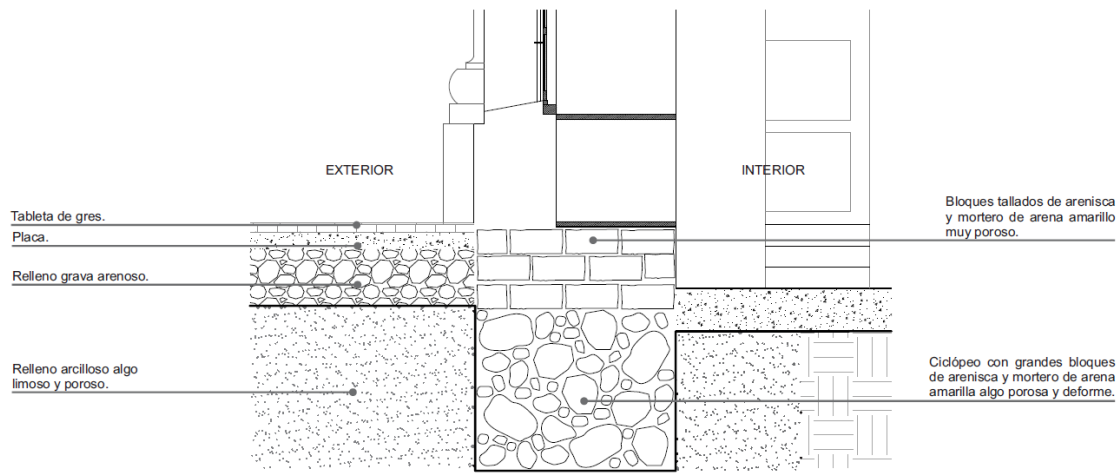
Esquema cambio de niveles exterior – interior en primera planta.
